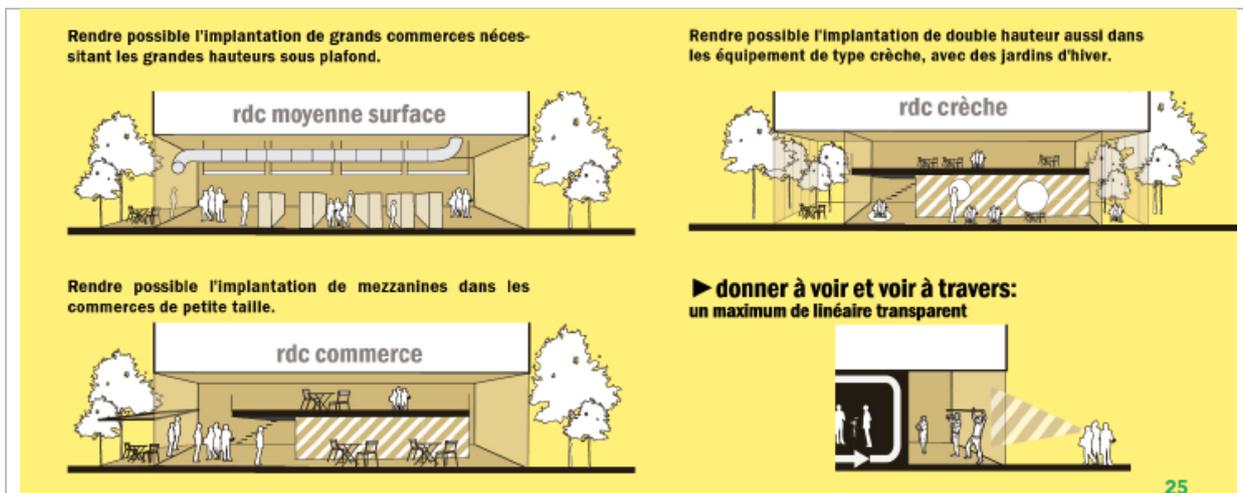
Activation au niveau des rez-de-chaussée (Source : Projet de PAD Mediapark.brussels, juillet 2018, n°20180706, document non approuvé)
